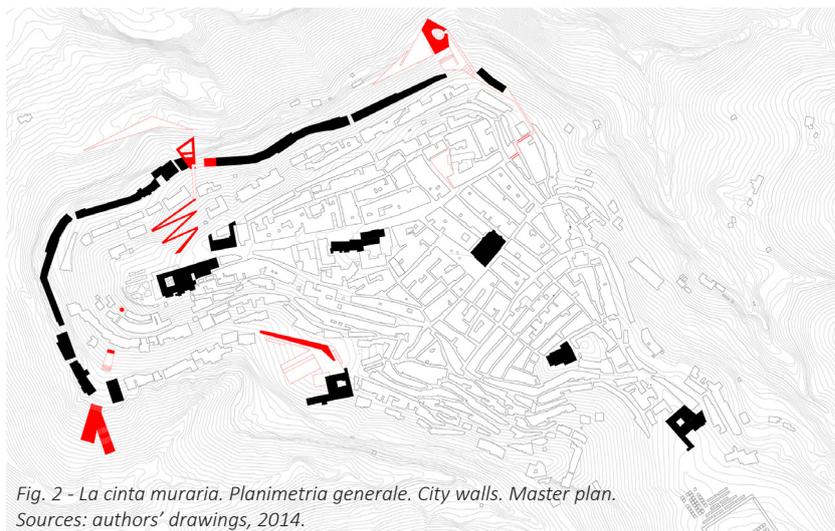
La cinta muraria. Planimetria generale. City walls. Master plan. Sources: authors' drawings, 2014.
